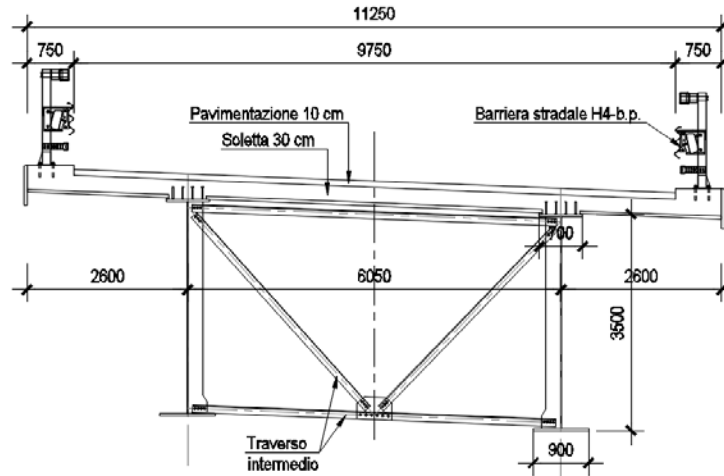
Sezione corrente impalcato Viadotto Eremita.
